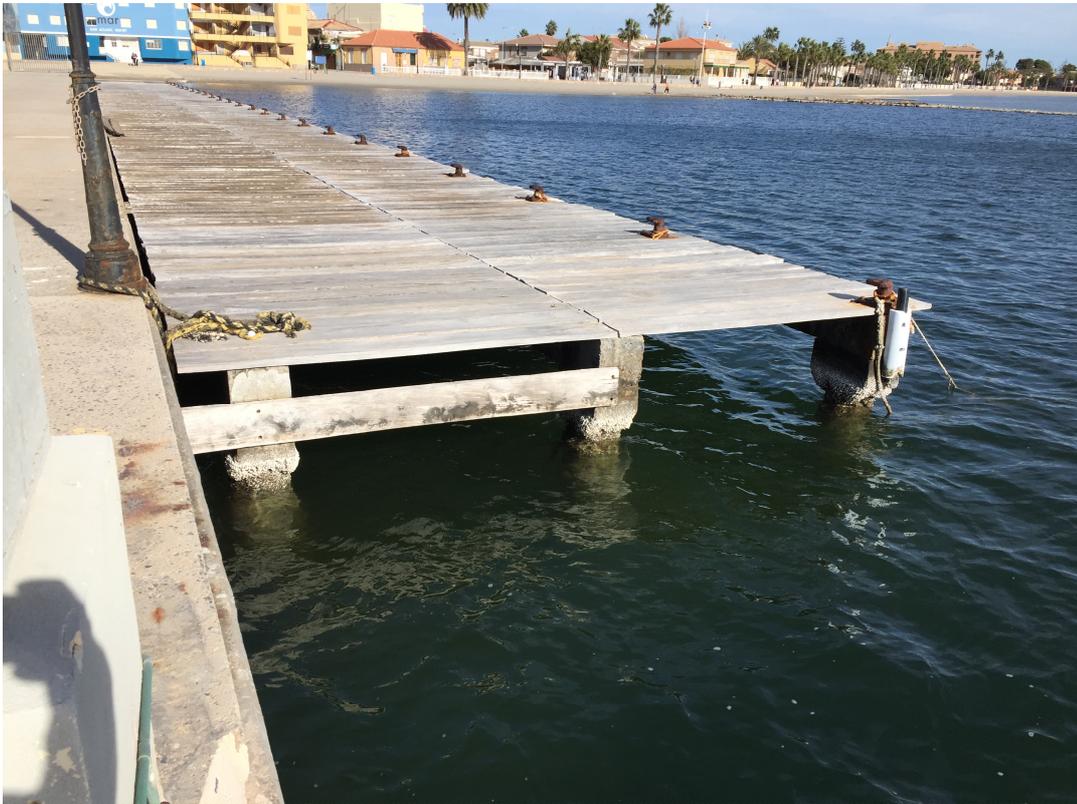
ARQUETA INEXISTENTE PANTALAN
